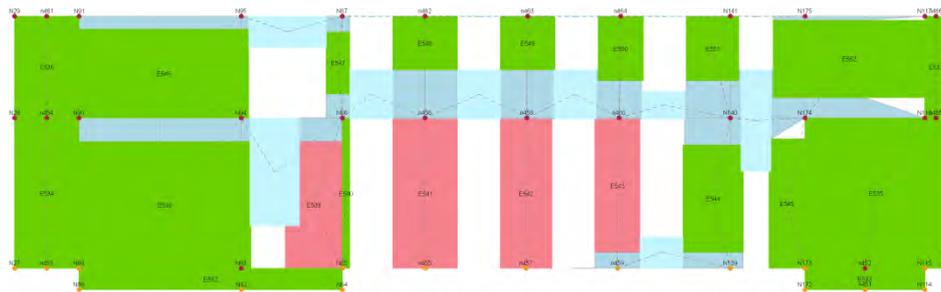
Individuazione dei maschi non verificati (in rosso) per la muratura del prospetto nord (parete 14)
